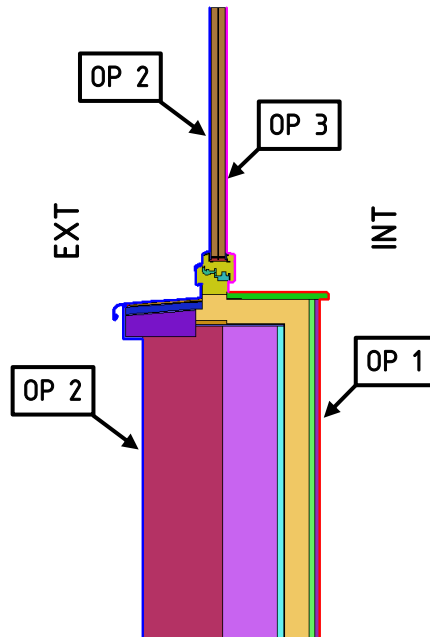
NÁVRH VNITŘNÍ ZATEPLENÍ – Parapet okna
